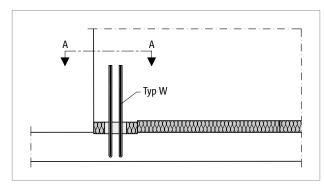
Schöck Sconnex $^{\circ}$ Typ W-N-VH: Bauseitige Bewehrung für Anschluss am Wandende
